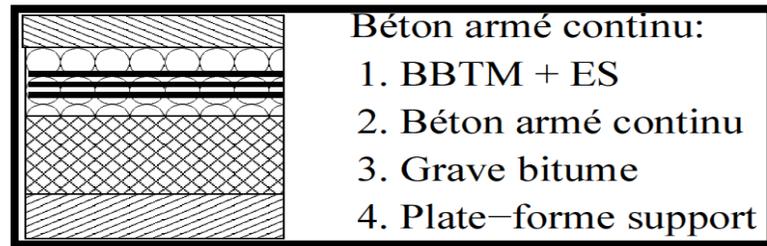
Béton armé continu sur Grave bitume (BAC/GB).
